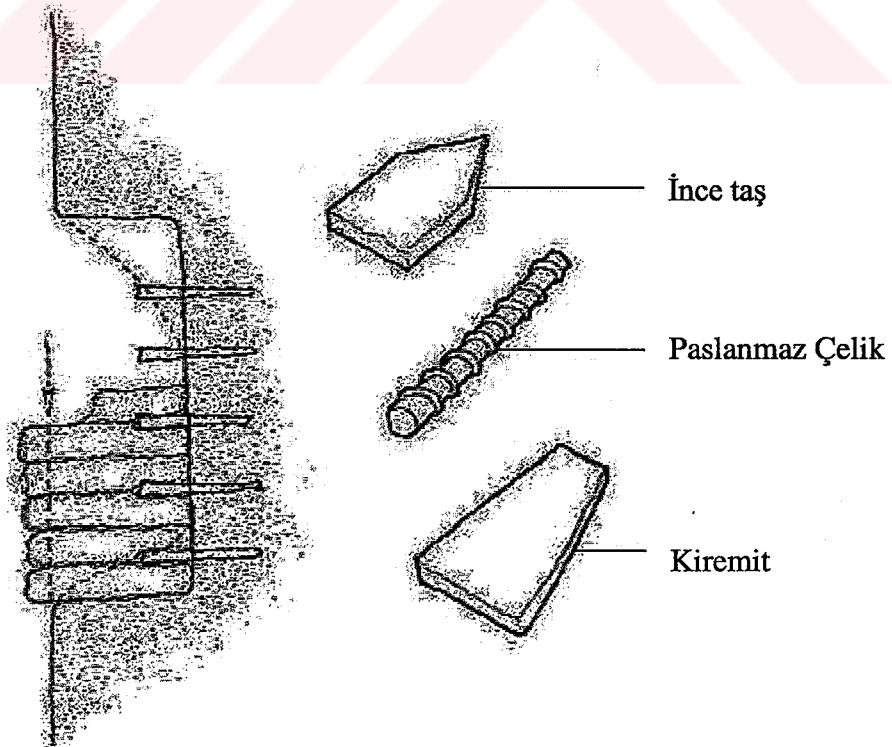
Tuğla ve Blok Kullanılarak Yapılan Onarım[3]
